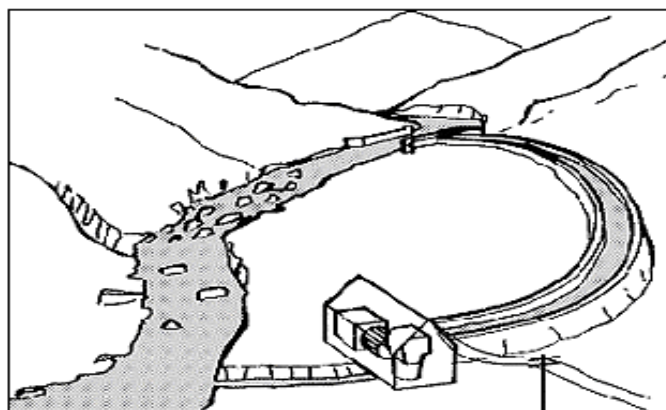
Central só com canal de adução e câmara de carga, queda baixa com central afastada da barragem
